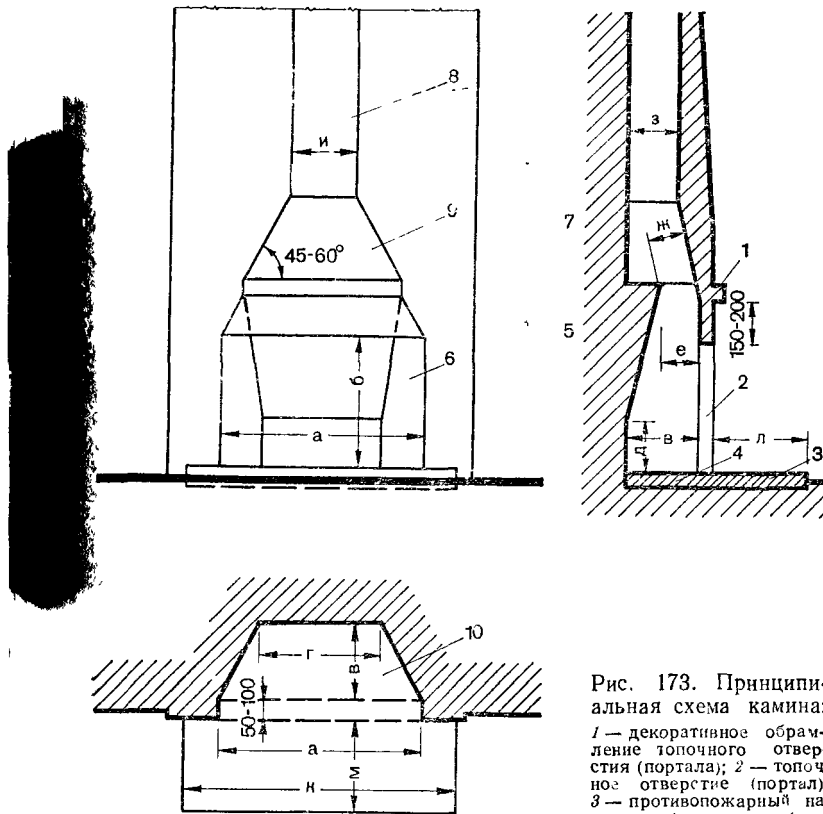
Принципиальная схема камин: 1 — декоративное обрамление топочного отверстия (портала); 2 — топочное отверстие (портал); 3 — противопожарный настил; 4 — днище (под
